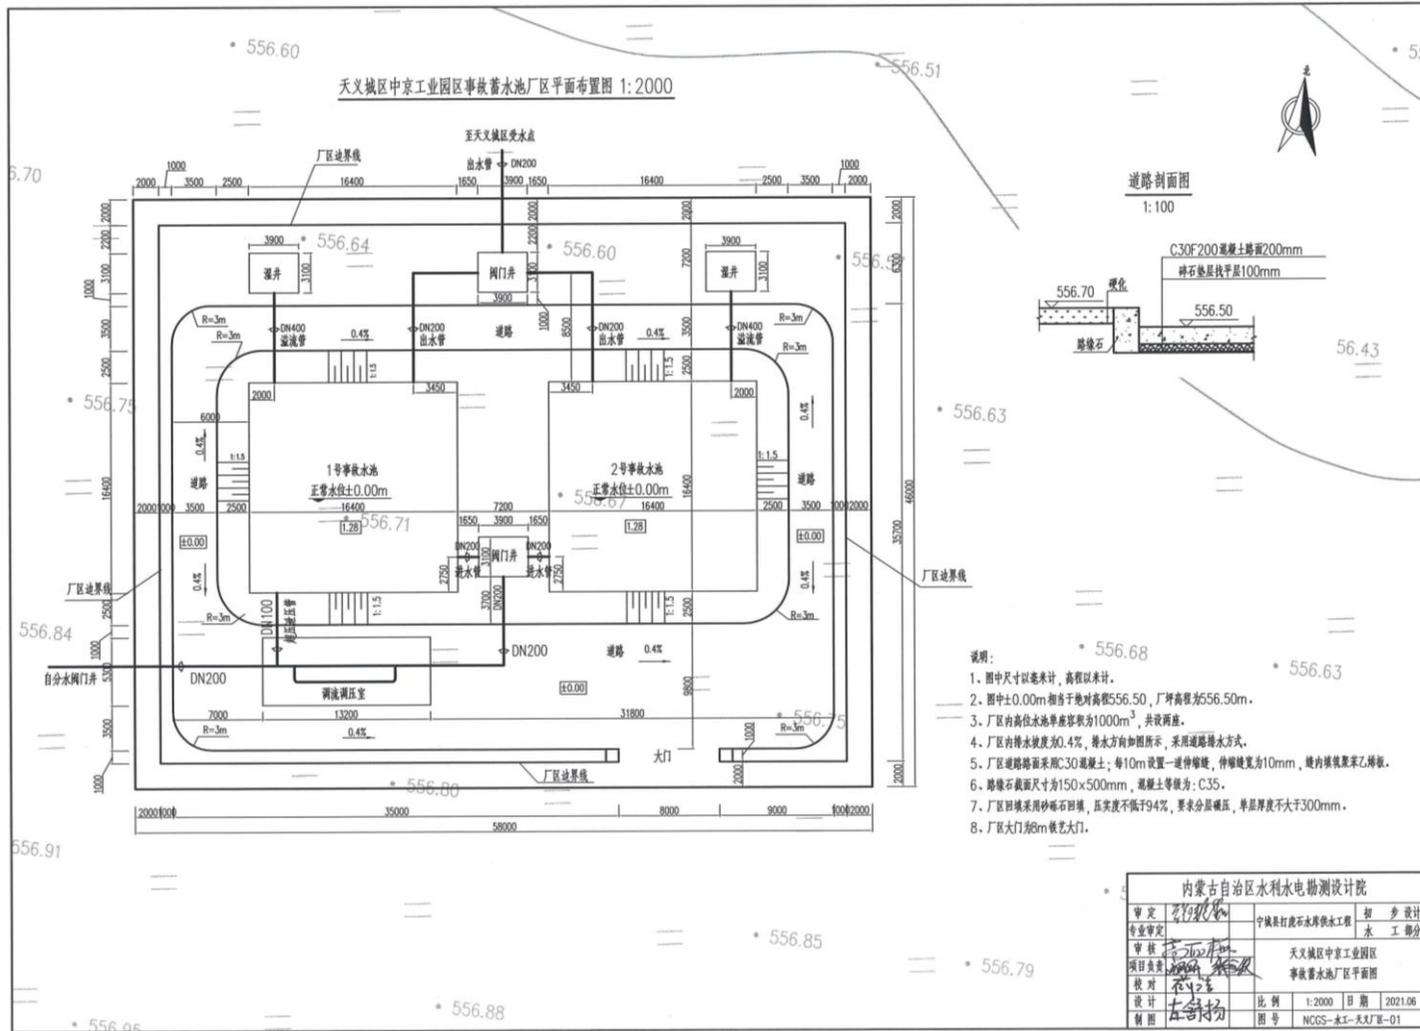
天义城区中京工业园区蓄水池厂区平面图
